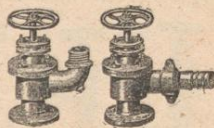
und 687. Hydranten mit Flansche und Normalgewinde für Schlauchverschraubung
